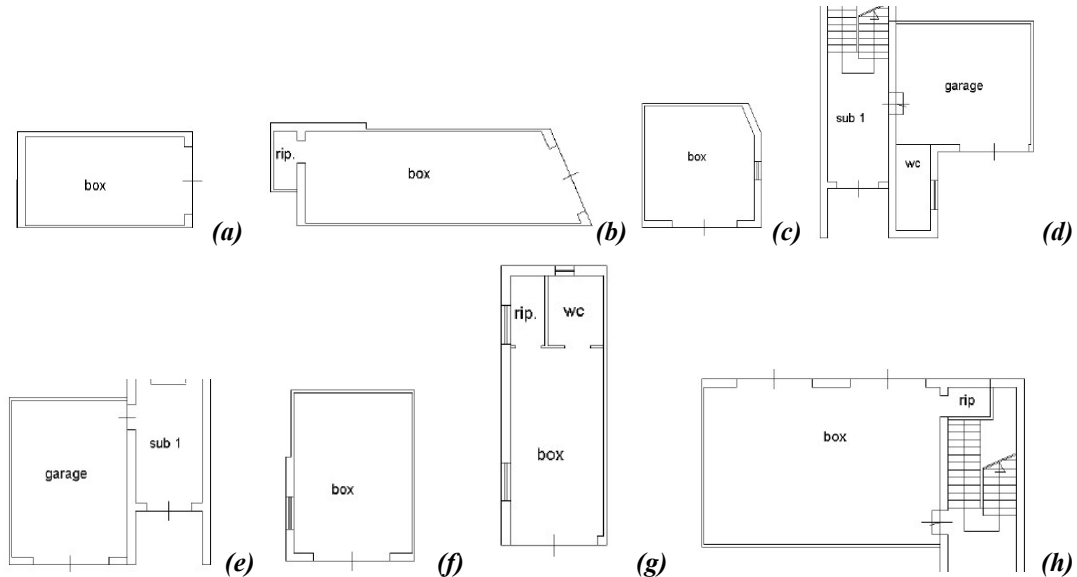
Planimetrie dei locali box o autorimesse a pianterreno ubicati in via Giro Esterno, via G. Rossini e via Cilea: BENE E (a); BENE F (b); BENE G (c); BENE H (d); BENE I (e); BENE L (f); BENE M (g); BENE N (h).
